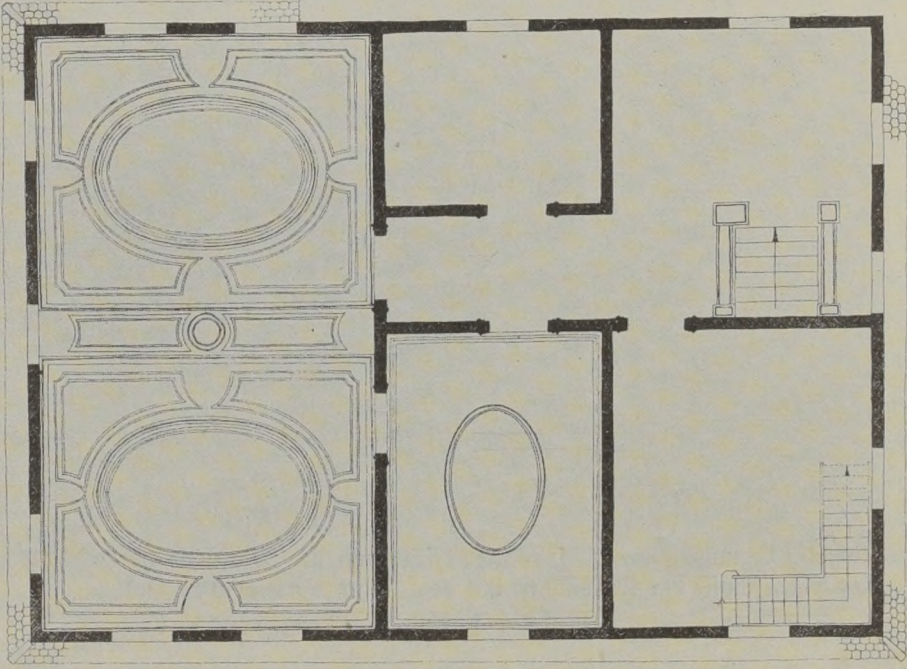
Grundriß des obersten Geschosses (Fachwerkgeschoß).
